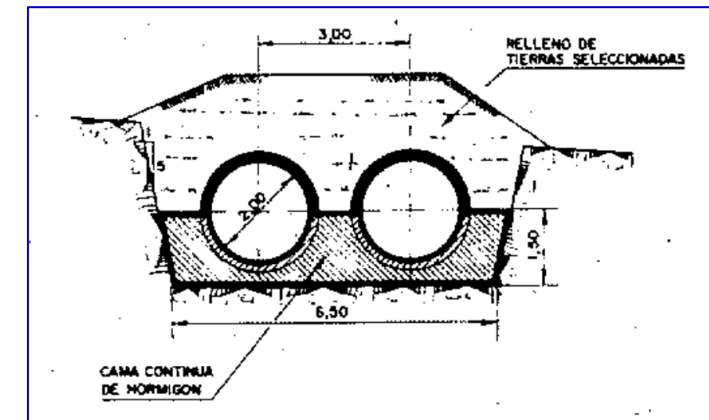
Sección del canal a la altura de la zona del Anteproyecto
